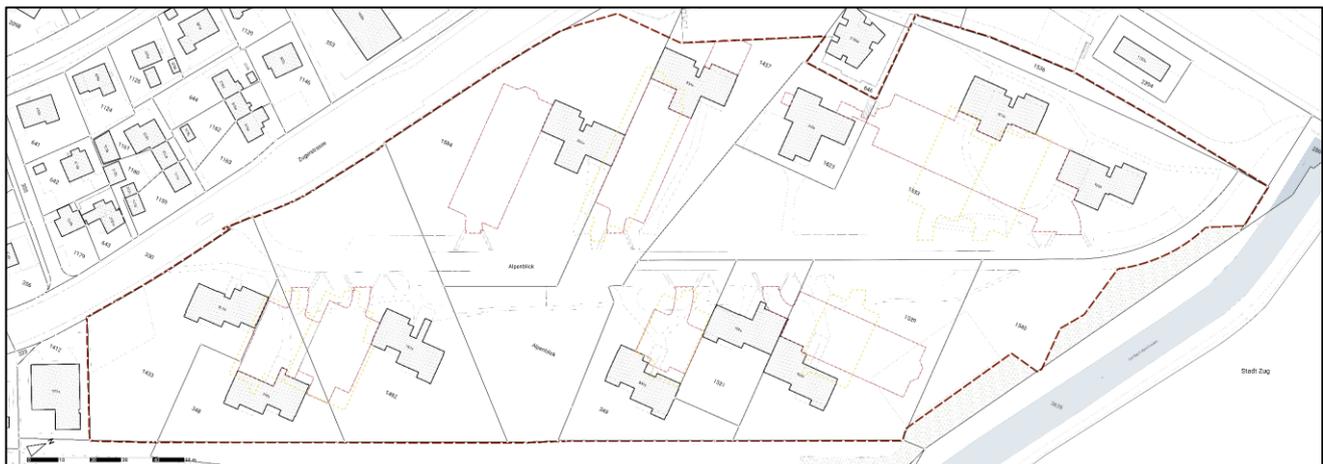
Differenzplan Baubereiche für Tiefgaragen und Unterniveaubauten Alpenblick. Vergleich rechtskräftiger und überführter Bebauungsplan
